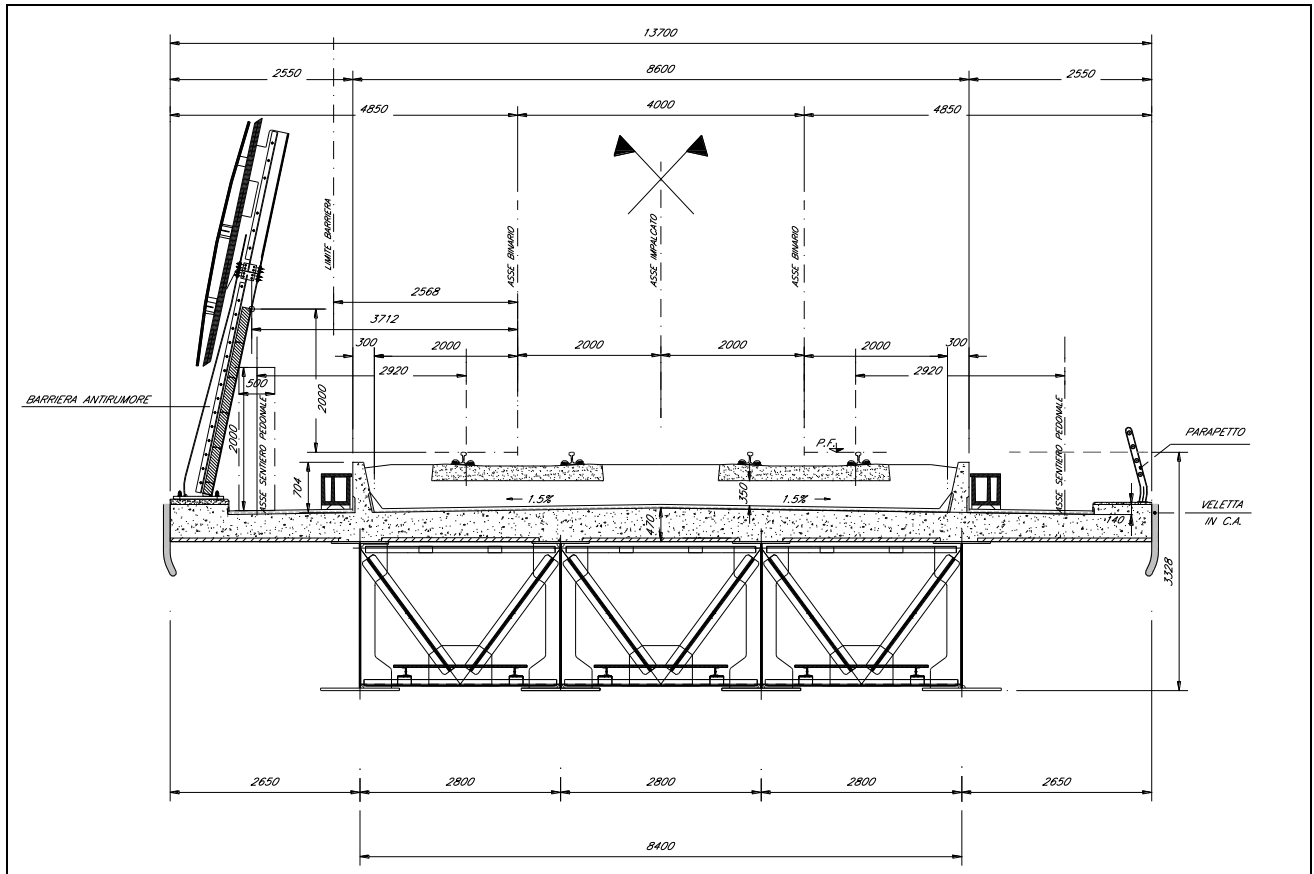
Sezione tipo impalcato misto acciaio-calcestruzzo. L=34.00m
